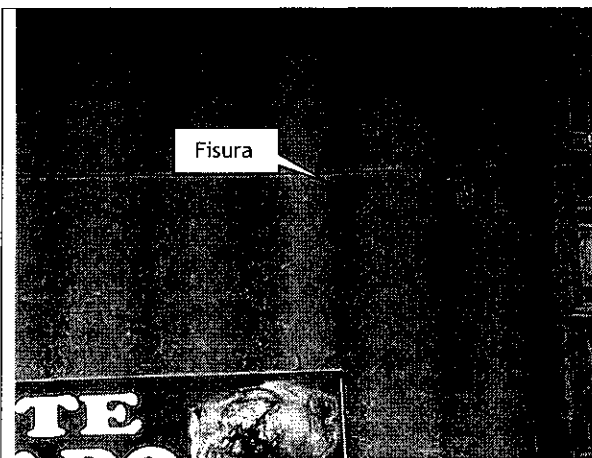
Fisura en muro de fachada (costado oriental sobre la Carrera 10).
